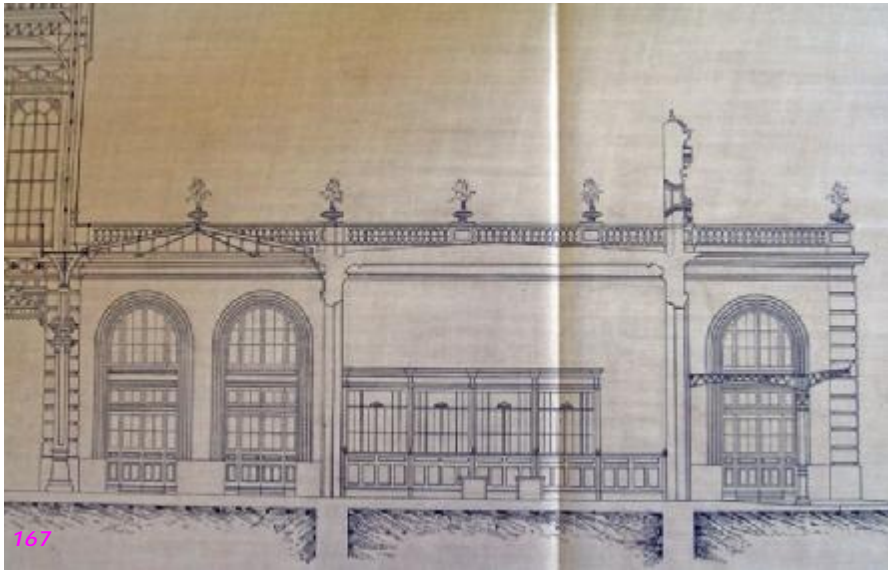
y 168.- Detalles de alzados y de cubierta. E. Madrid P Pio. (FFE - A. propio 2010).
